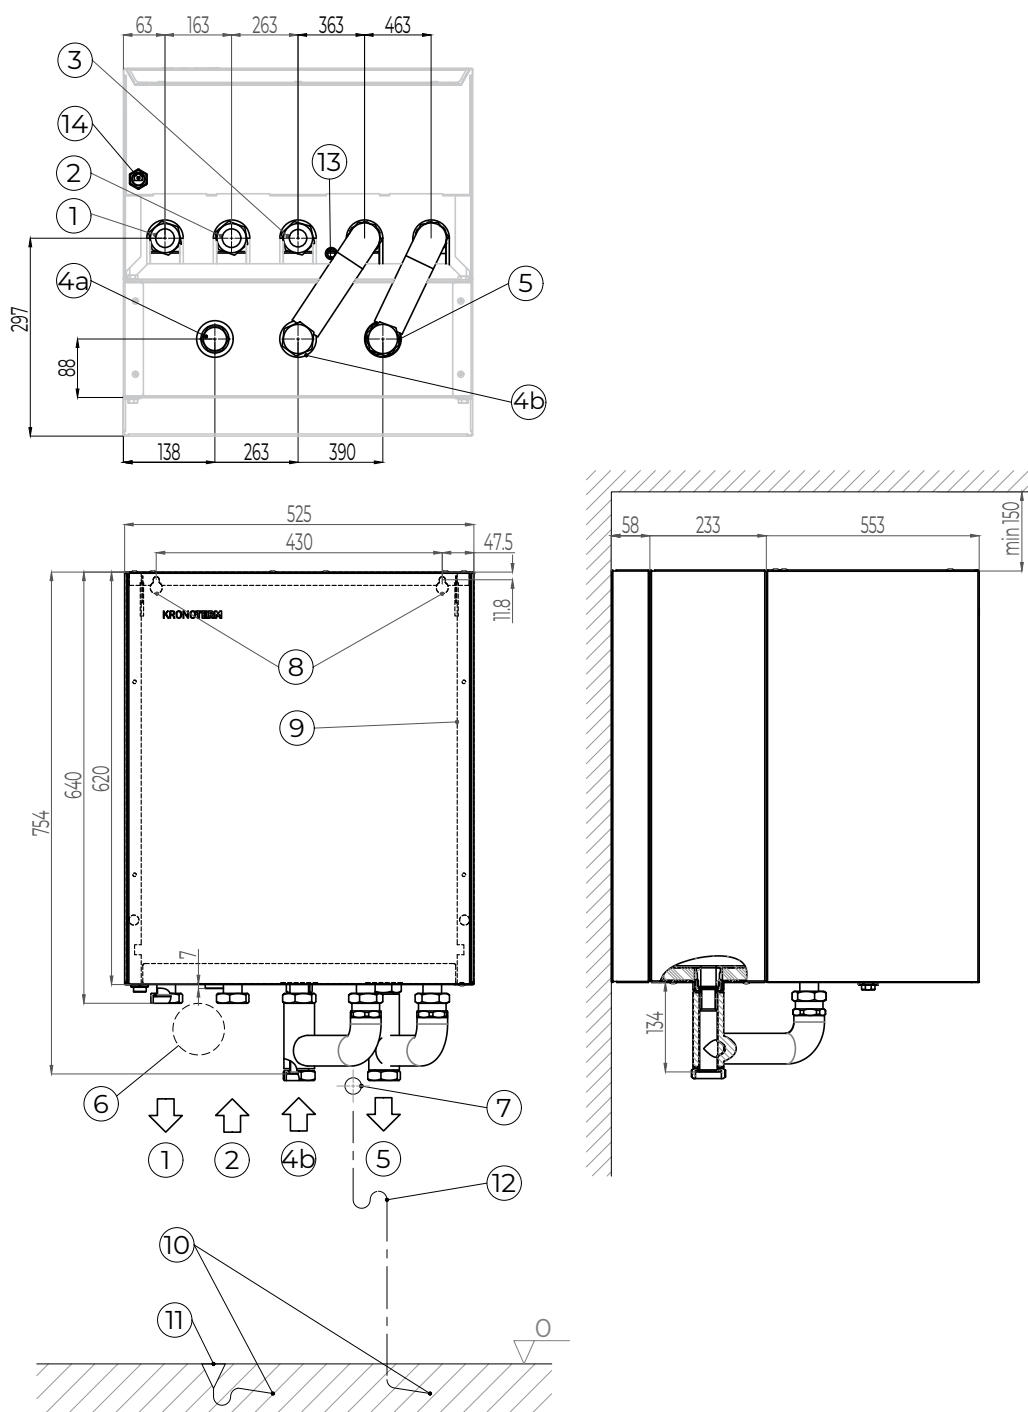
Bijlage 4 - Plan voor de installatie van de HYDRO S2 + HYDRO P2
